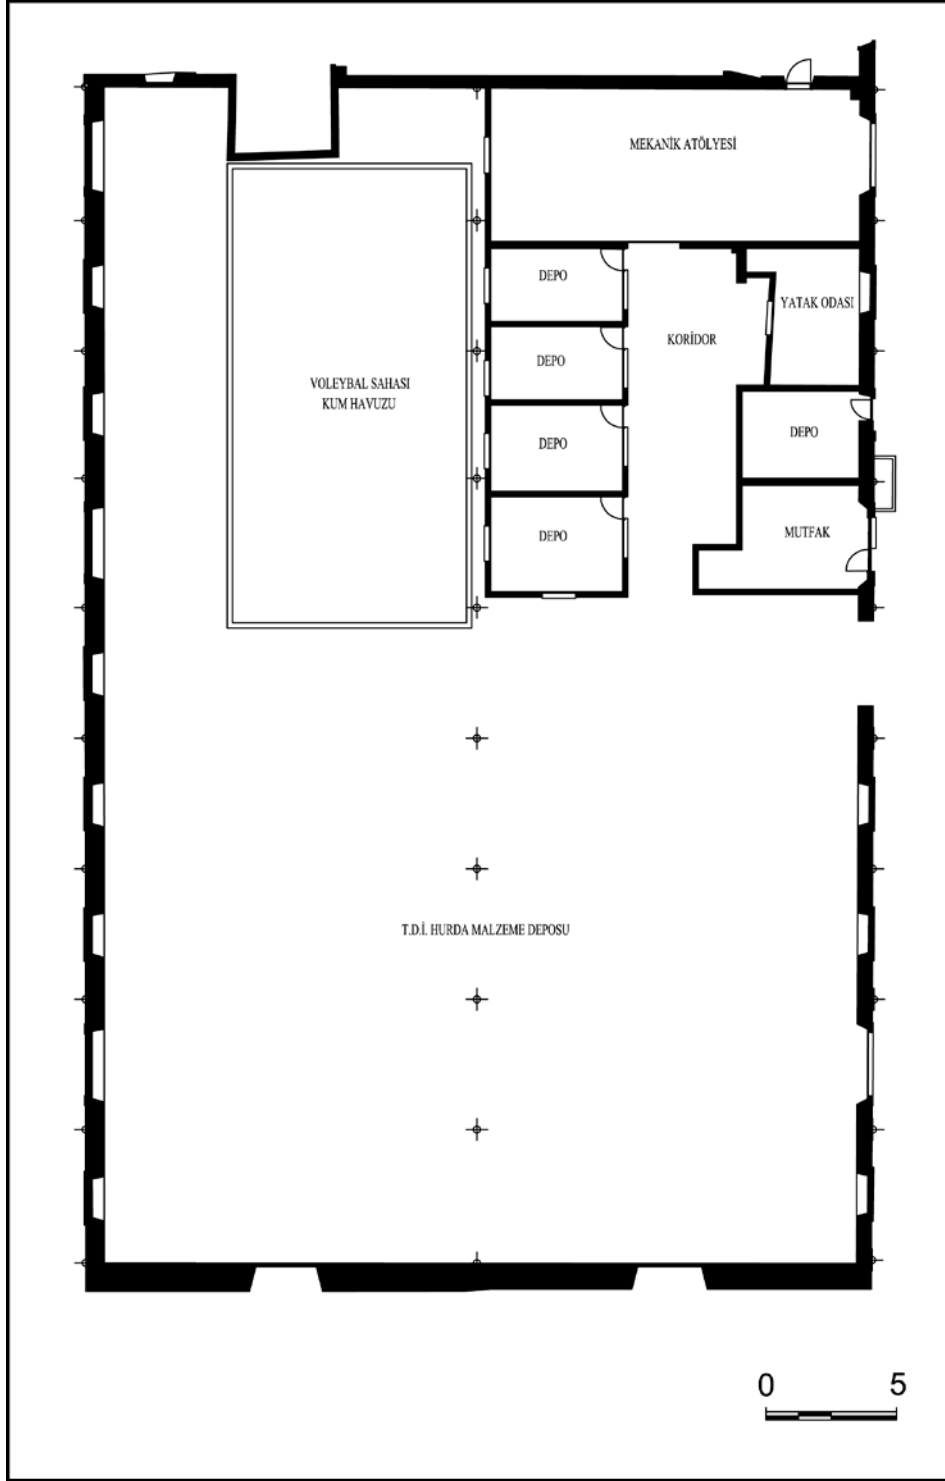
I. Dönem Hurda Ambarı 2 Binası Plan Şeması
